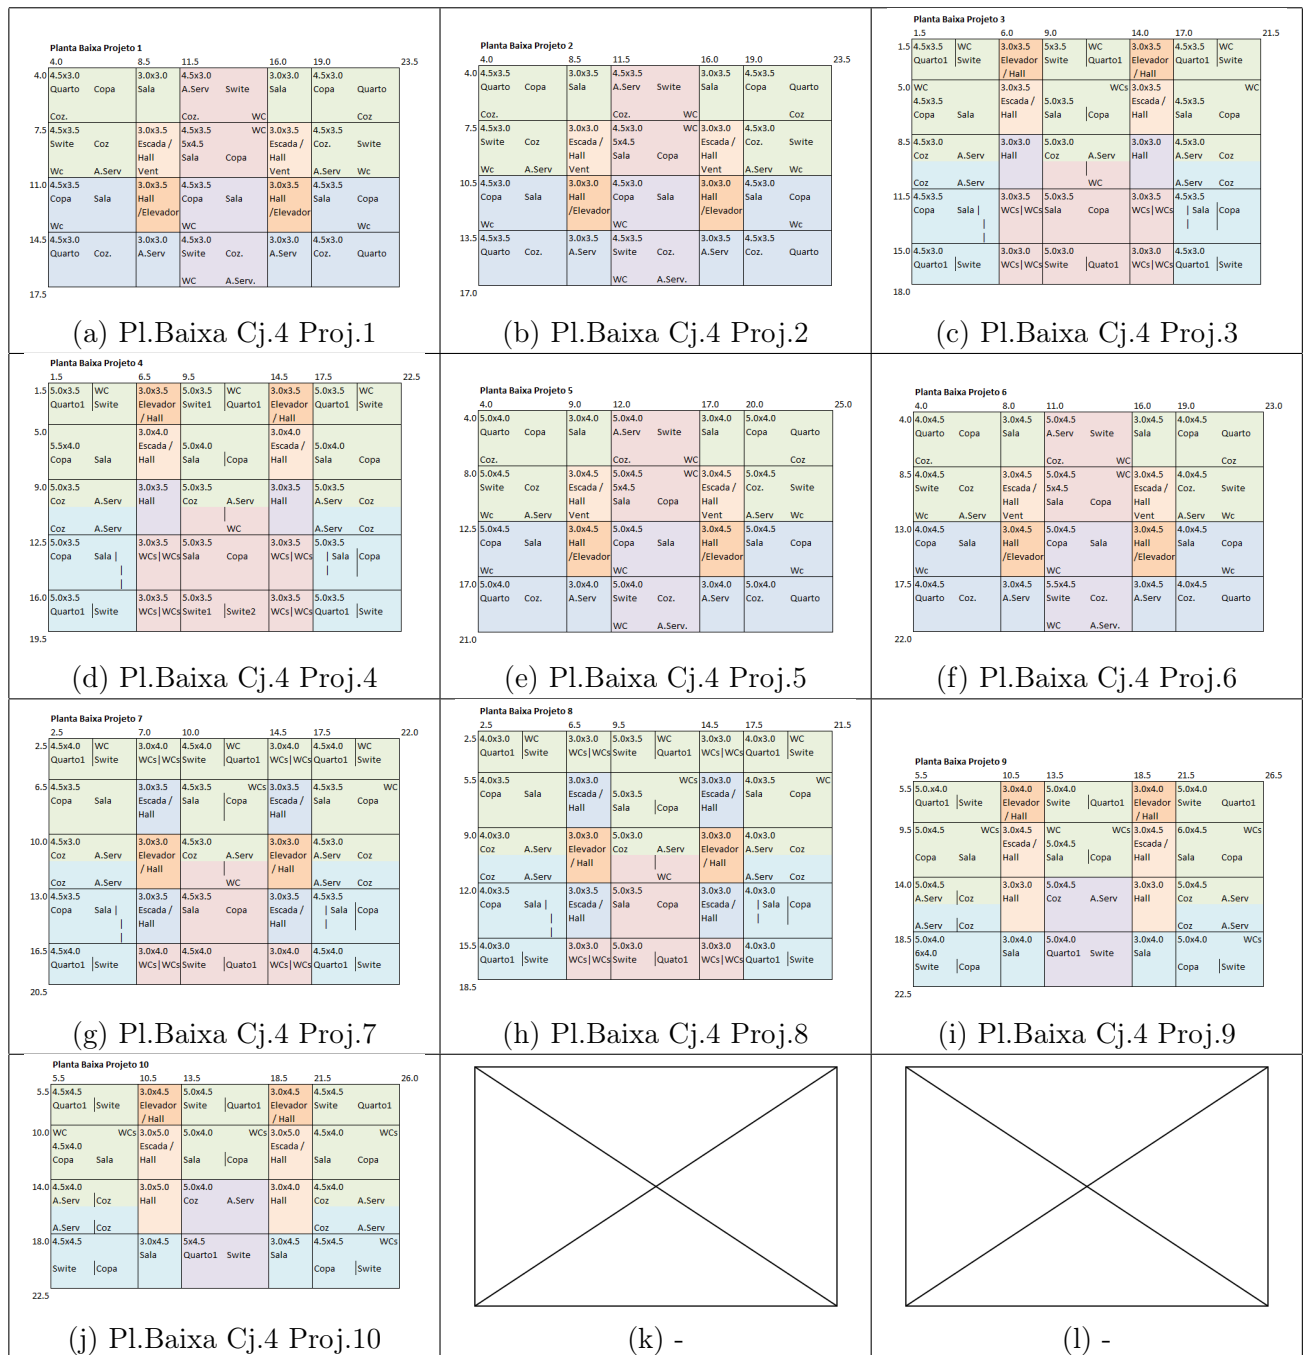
Plantas Baixas - Cj.4 - Pjs.Treino 1 a 7 - Teste 8 a 10
